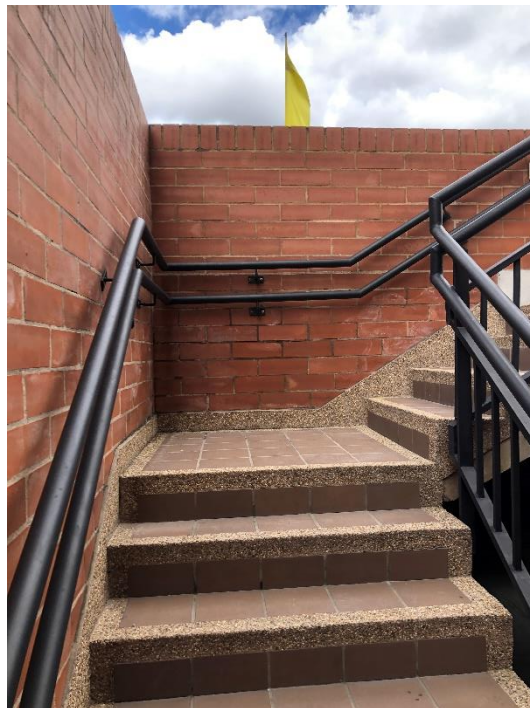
Muros Escalera con humedad salida hacia el parqueadero V-22
